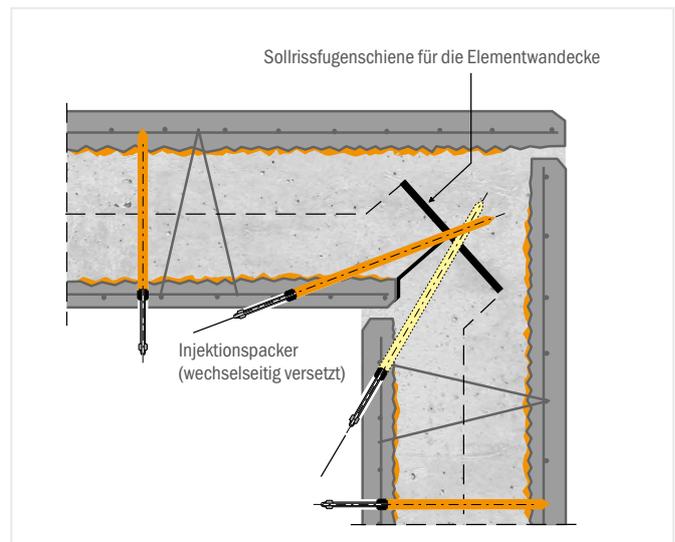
c: Nachträgliche Abdichtung einer Elementwanddecke mit einer Sollrissfugenschiene [8]
